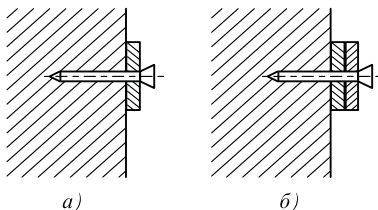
Крепление заземляющих проводников дюбелями непосредственно к стене (а) и с подкладкой (б)
